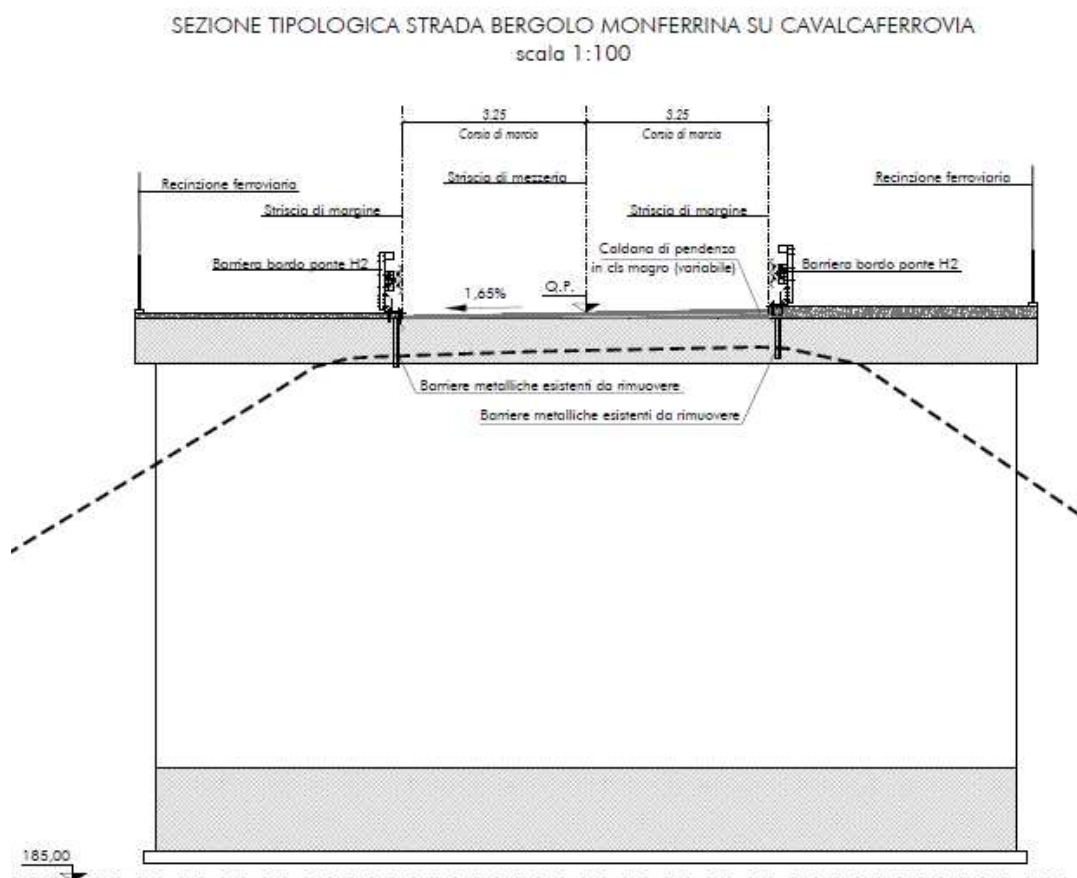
Strada Bergolo Monferrina - sezione tipo su cavalcaferrovia in progetto
